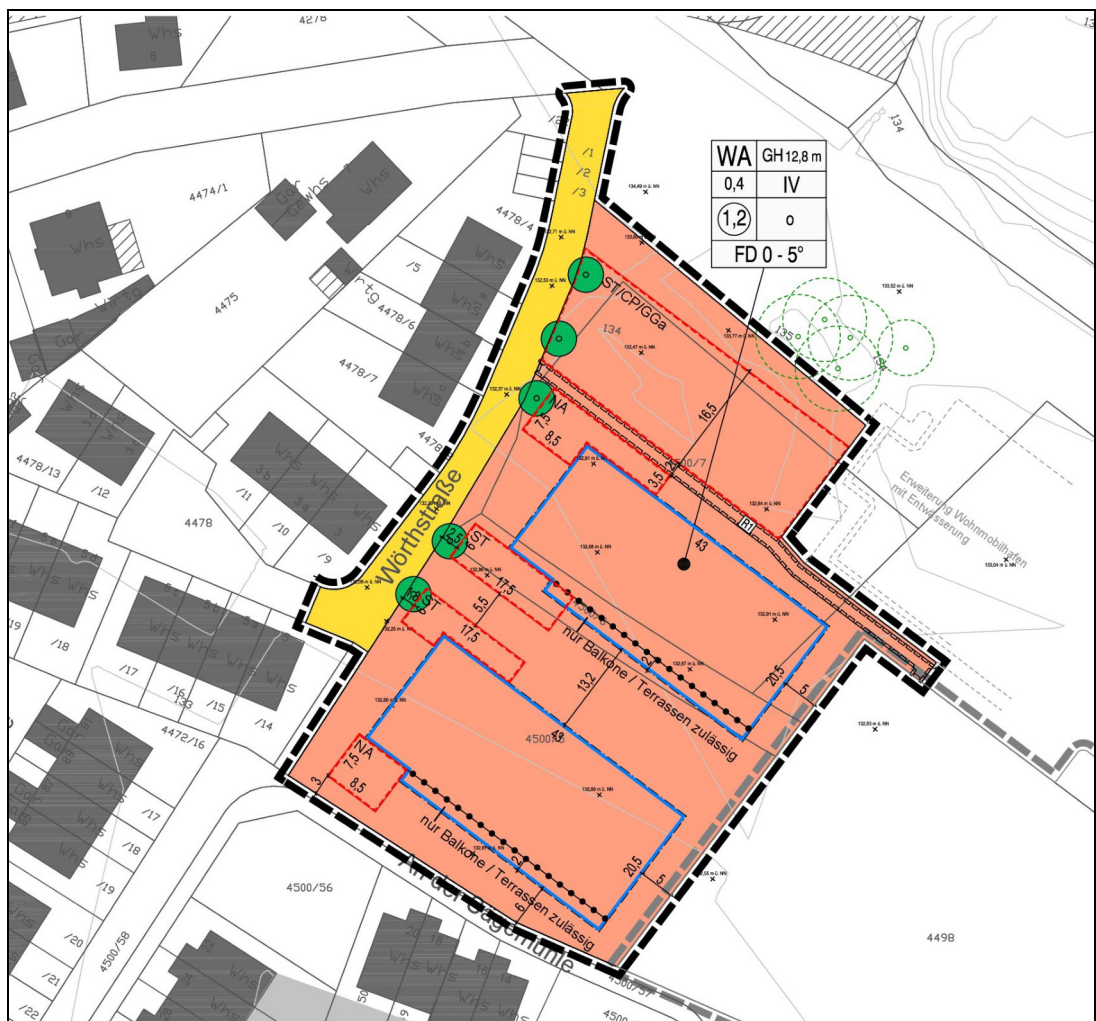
Bebauungsplan „Wohnbebauung Wörthstraße“ (Quelle: fsp Stadtplanung, 2023 [1])
